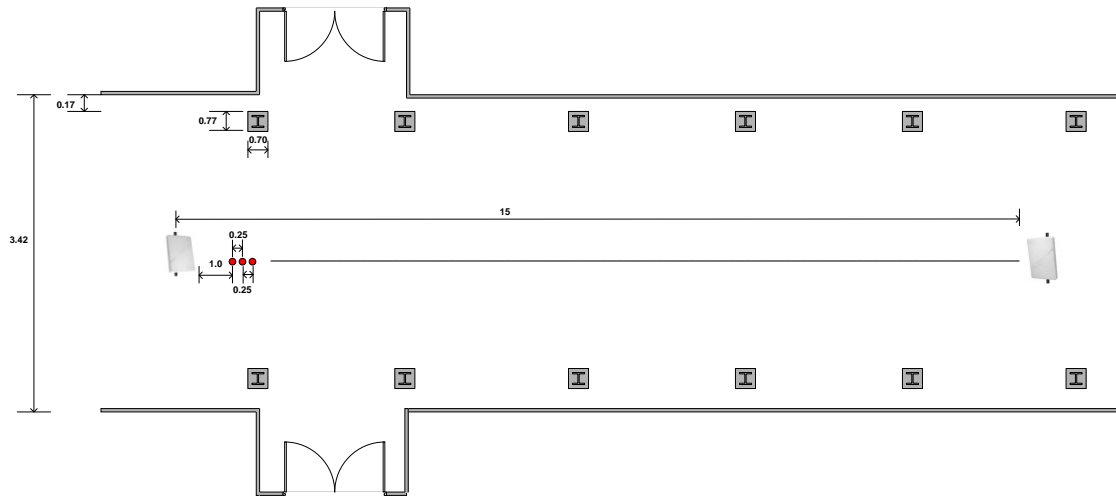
Plano del pasillo junto a las aulas A06 – A09, primer piso, Edificio A
